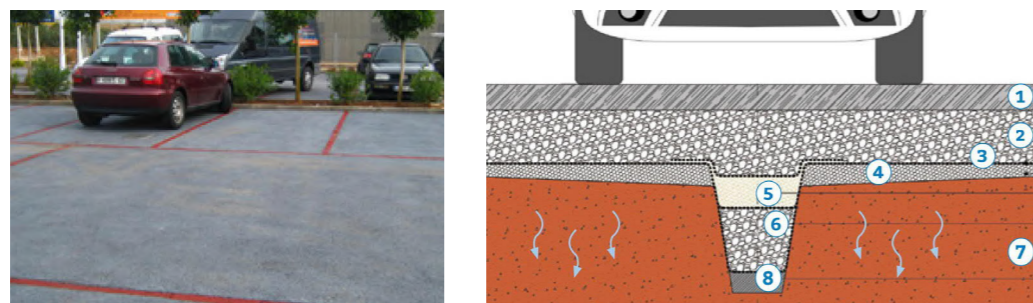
Imagen y esquema de aparcamiento con pavimento drenante de hormigón poroso.
